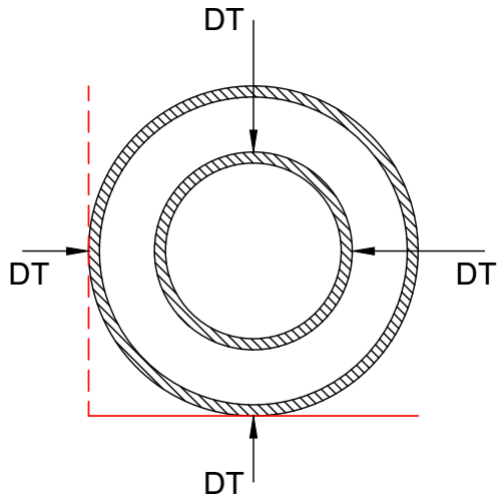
Chapas soldadas ao tubo externo.
